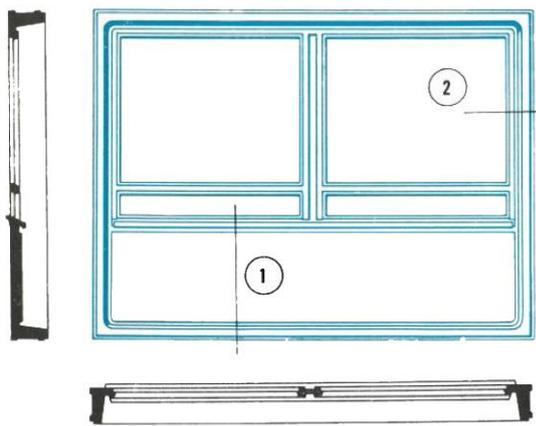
Schéma d'un élément de façade préfabriqué en Schokbeton.
